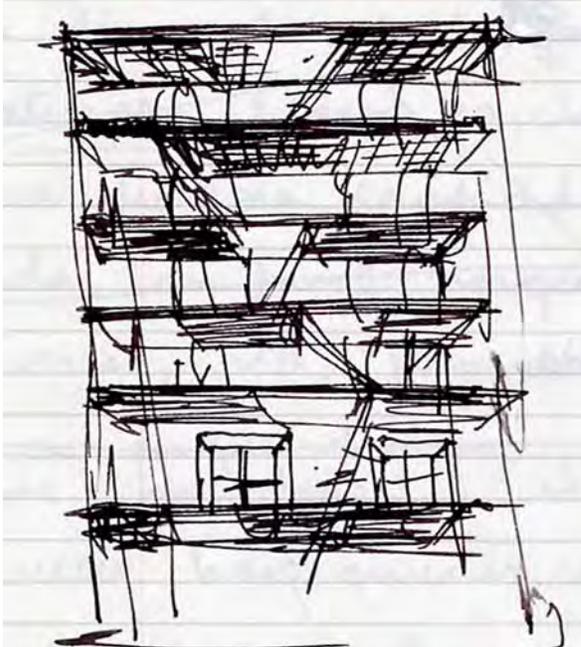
CROQUIS SOBRE ESTRUCTURA DE ANDAMIAJE QUE DEMUESTRA LA ESPACIALIDAD DE LA FACHADA.
